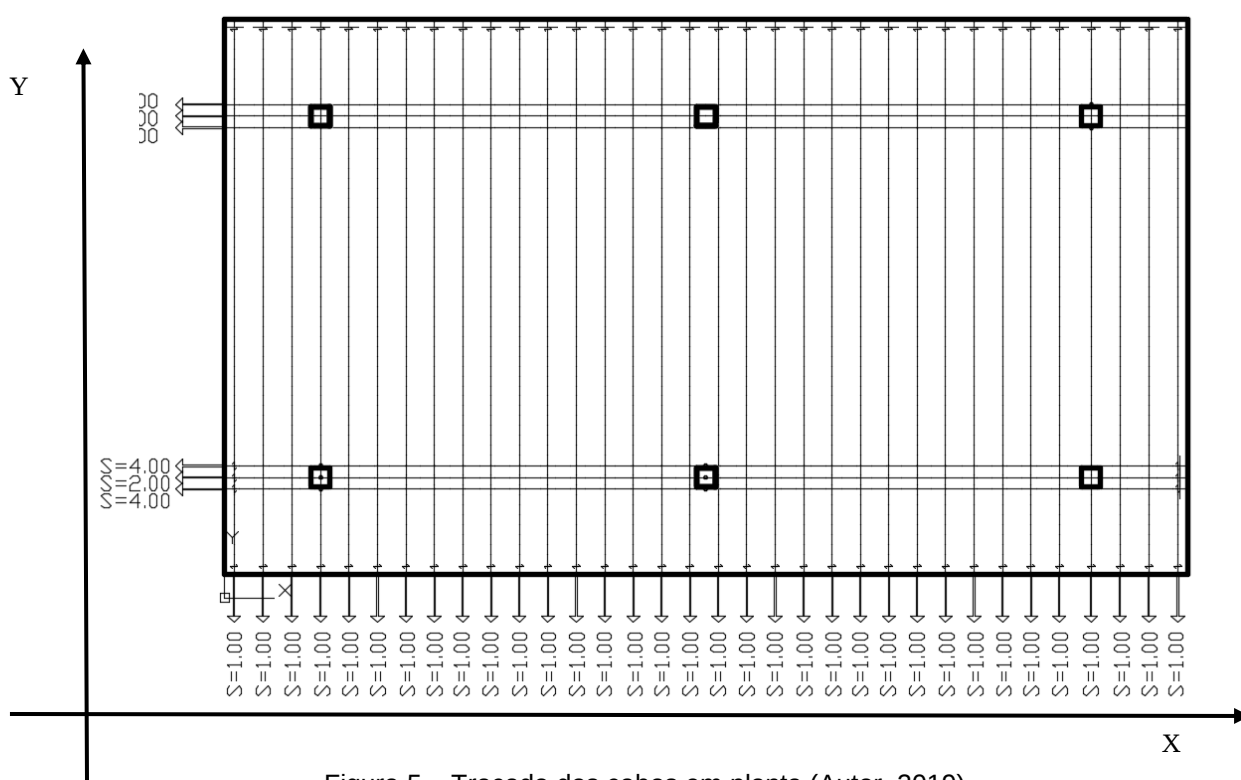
Traçado dos cabos em planta (Autor, 2019)
